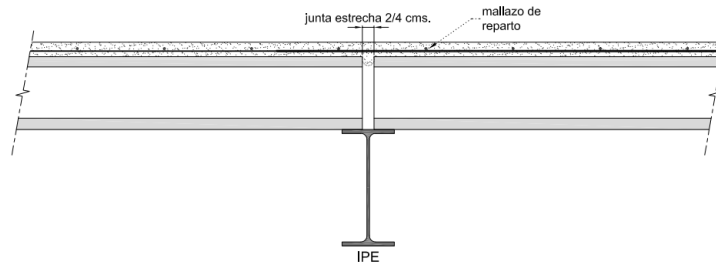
DETALLE CONSTRUCTIVO APOYO PLACA ALVEOLAR SOBRE PERFIL IPE
